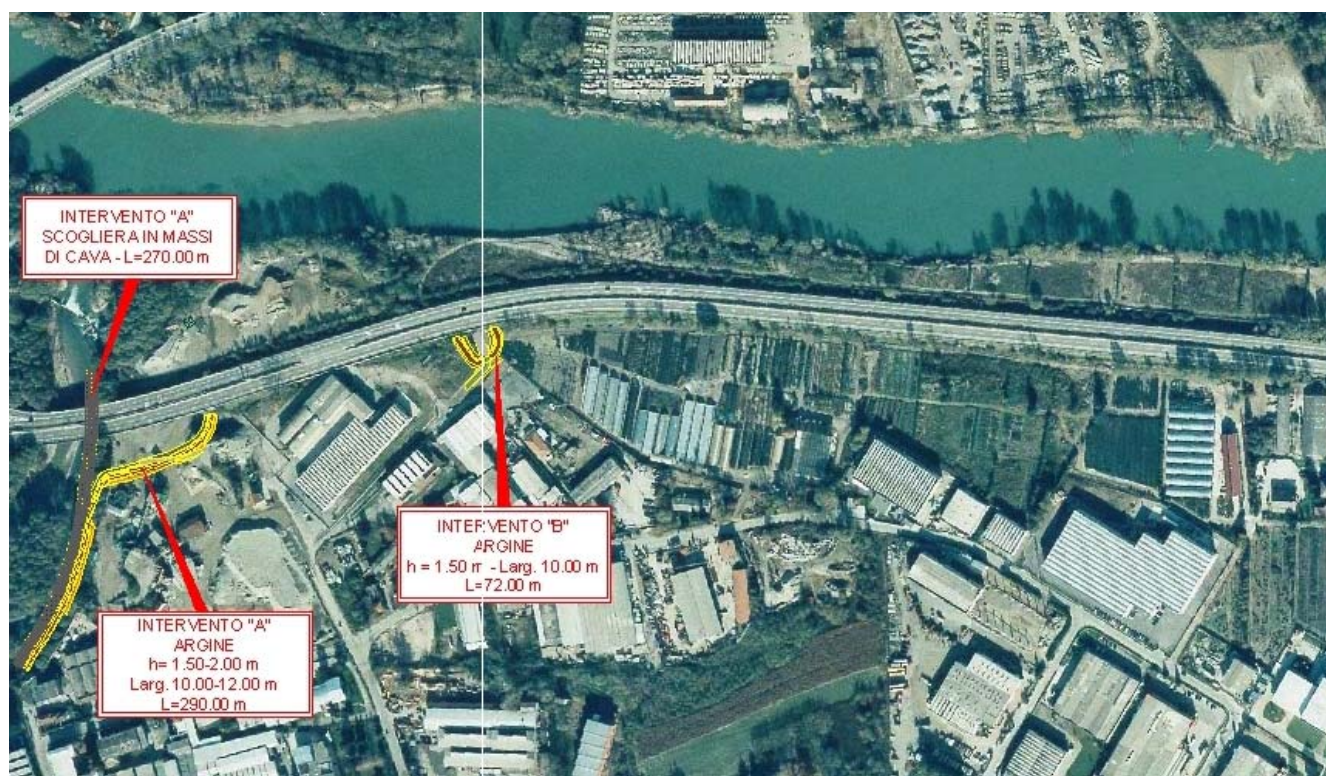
Ortofoto localizzazione interventi di progetto (tratto di monte)
